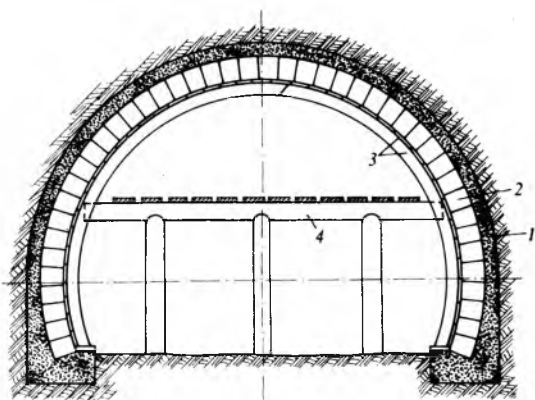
Definitivna podgrada od monolitnog betona. 1 privremena podgrada od čeličnih profila i štrcanog betona, 2 definitivna podgrada od monolitnog betona, 3 nosiva konstrukcija i oplata za betoniranje, 4 radna platforma
